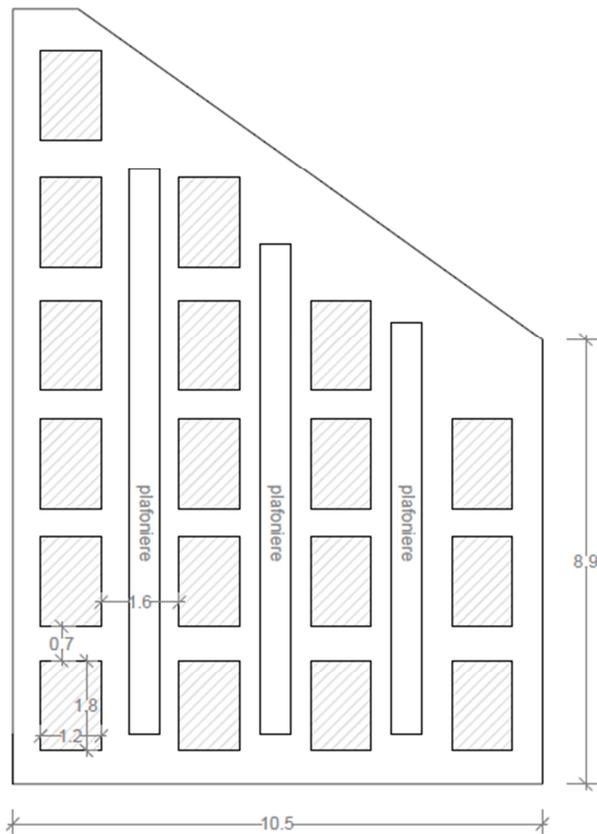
Individuazione intervento installazione pannelli fonoassorbenti
